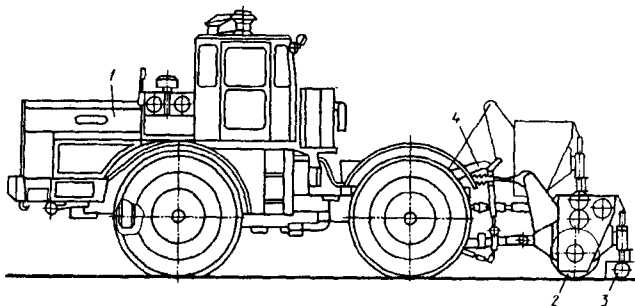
Машина ЭД-94 для фрезерования разогретых асфальтобетонных покрытий: 1 — тягач; 2 — фреза; 3 — опорное устройство фрезы; 4 — механизм подъема и опускания фрезы.
